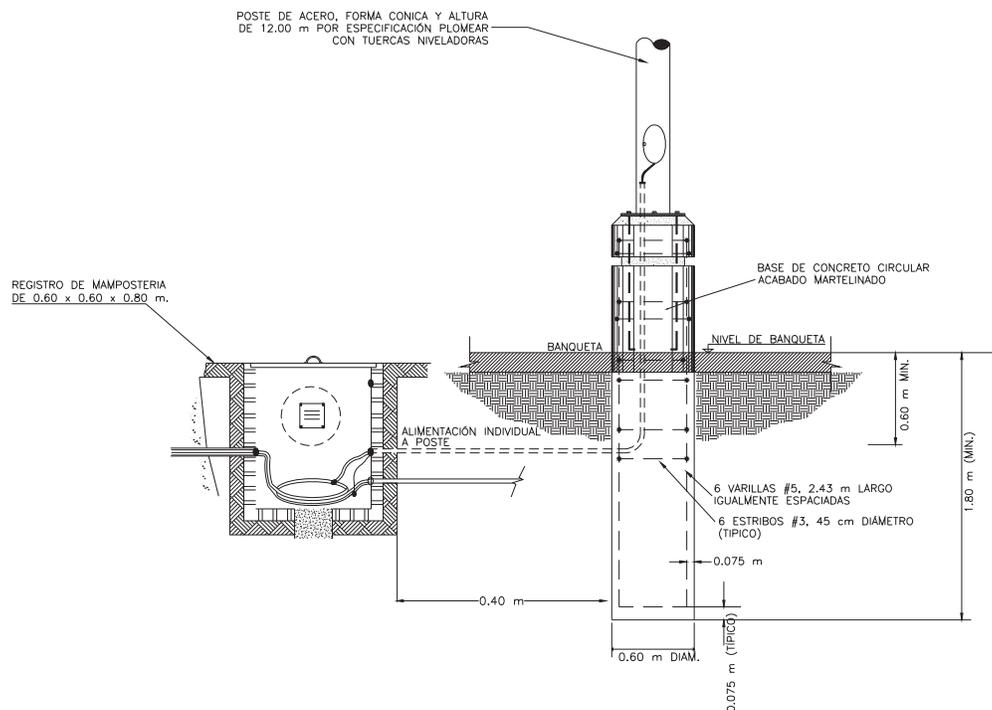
Detalle típico de cimentación de postes cónico.
